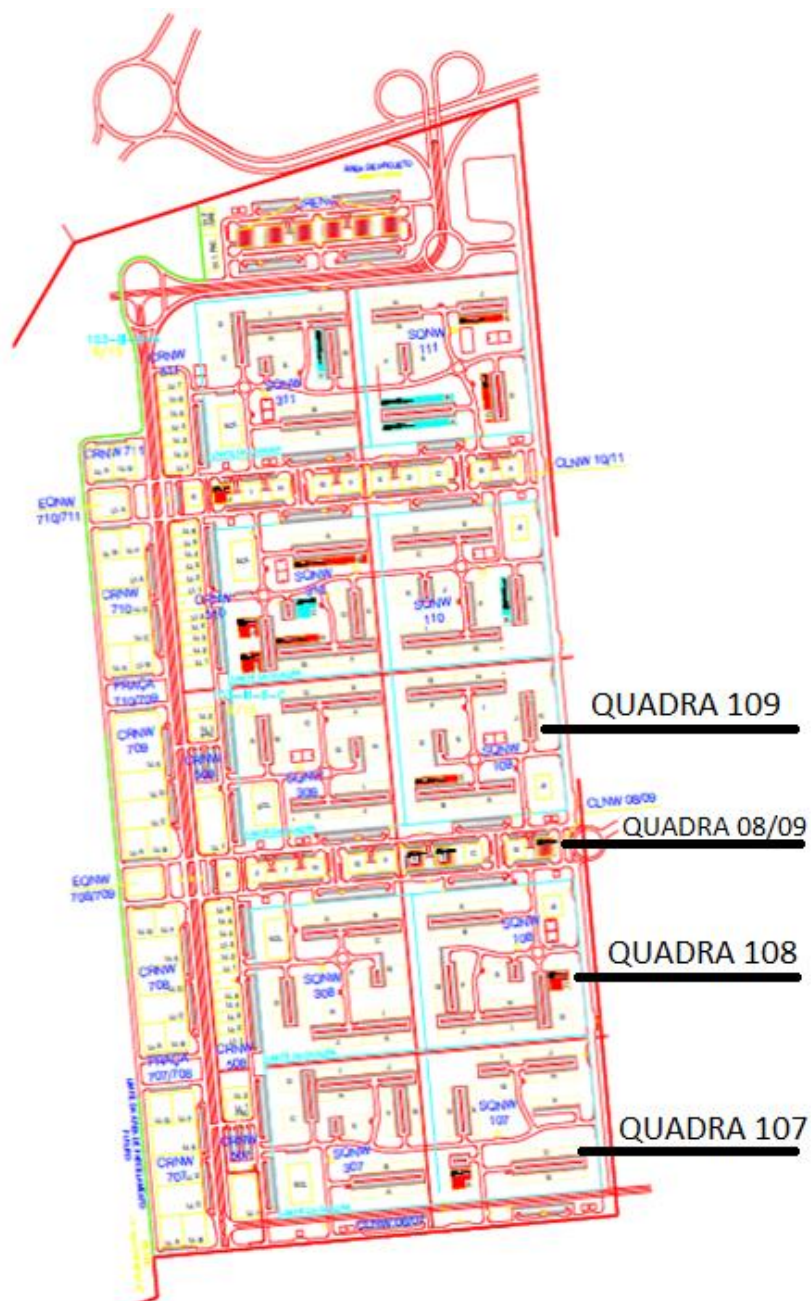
Planta baixa Noroeste. (Arquivos FUNDEX/INFRASOLO)
